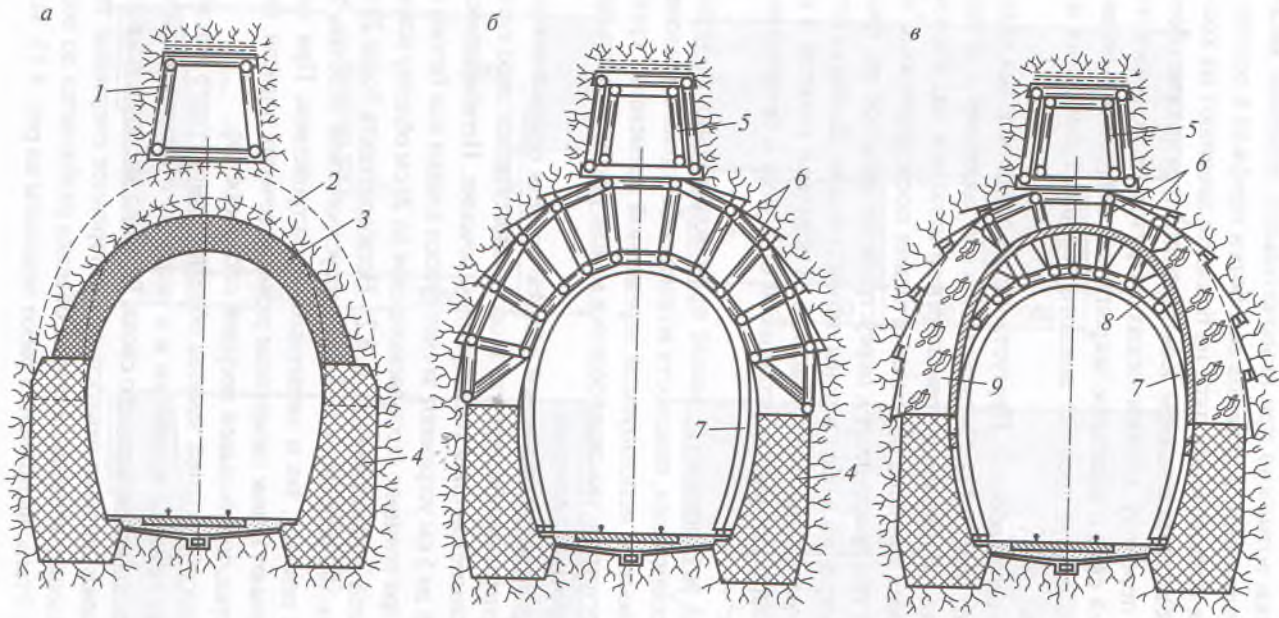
Этапы работ при переустройстве свода наружным способом:
